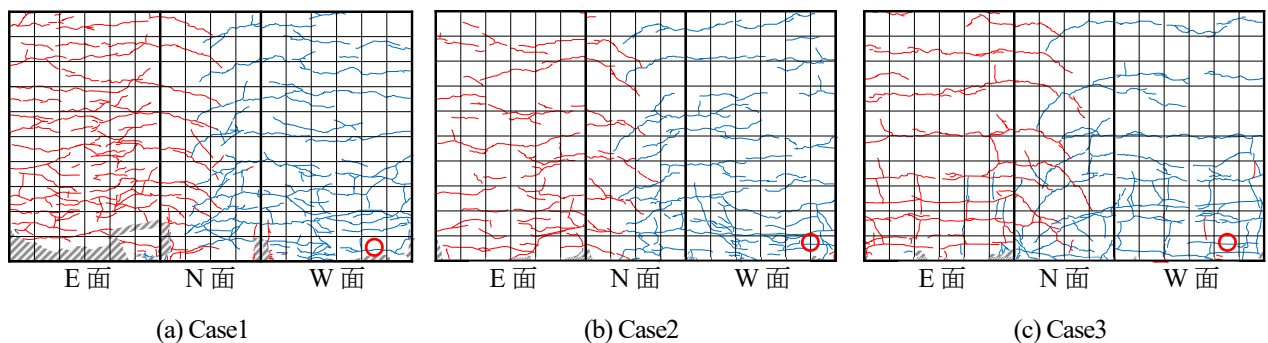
ひび割れ性状スケッチ (+5 δ_y)
